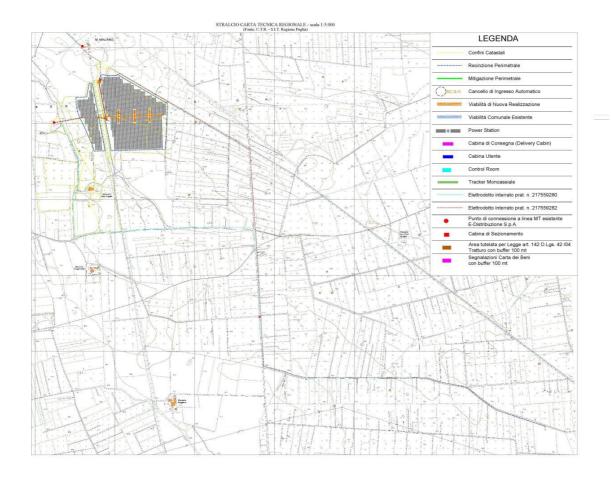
Area di intervento su C.T.R. Sezione 495132 Stazione Avetrana e Sezione 511011 Masseria Ruggiano.
